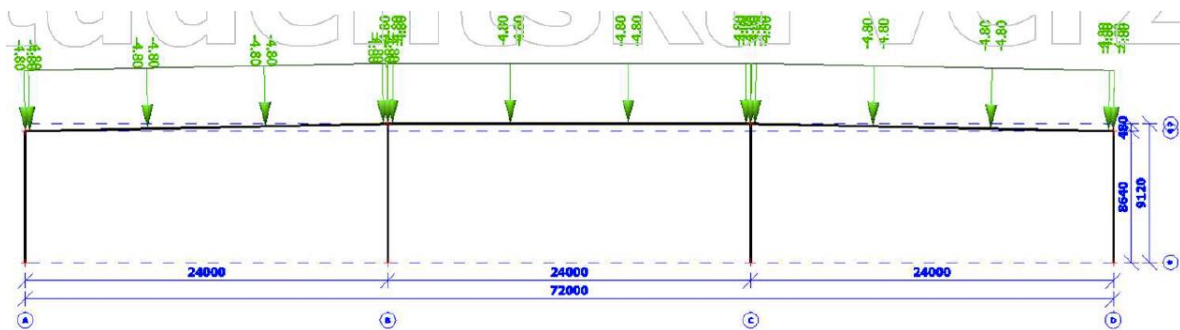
Zatížení - vlastní tíha konstrukce
